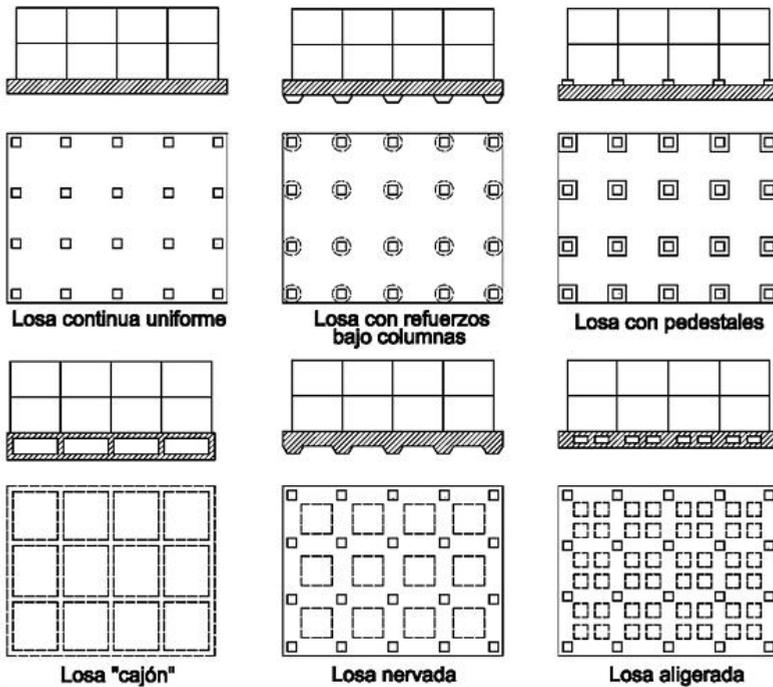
Tipos de losa de cimentación, según CTE DB SE-C.
